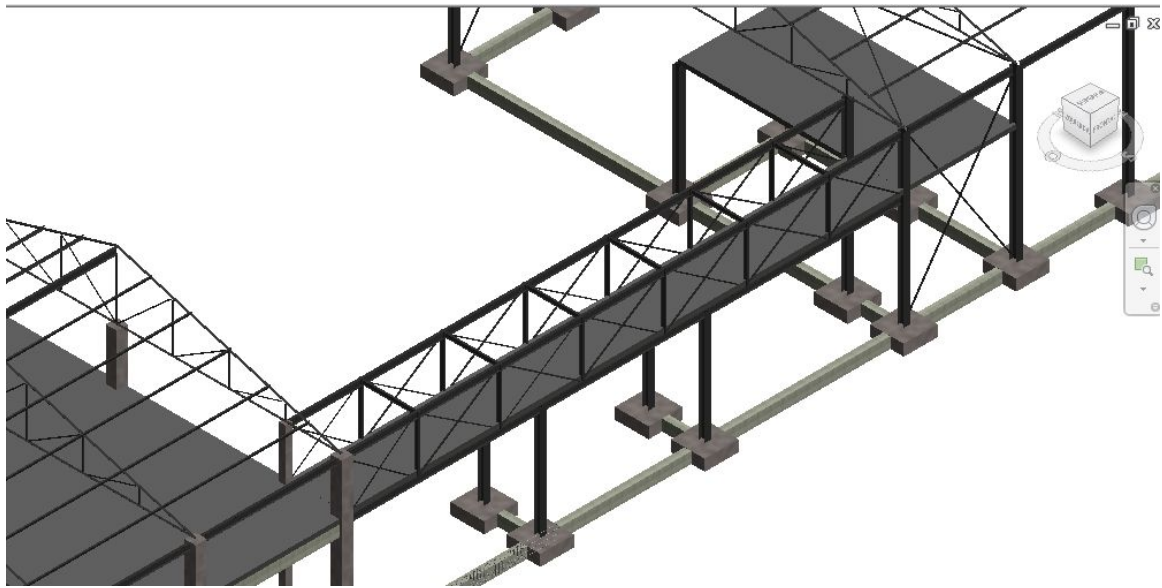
Suelo de hormigón en Planta 1 en el puente.
